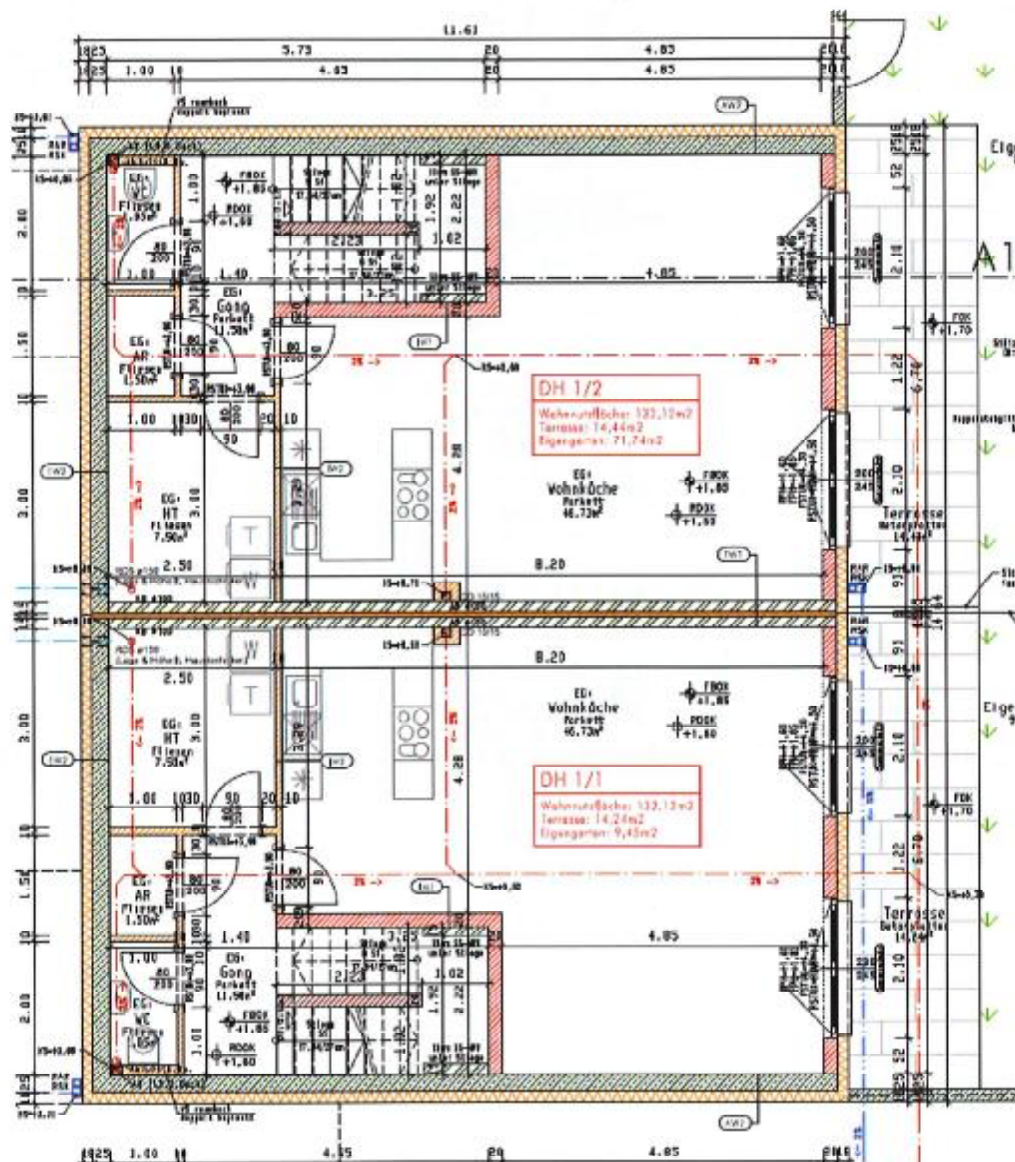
Grundriss EG | Doppelhaus 1 | 21.10.2021
